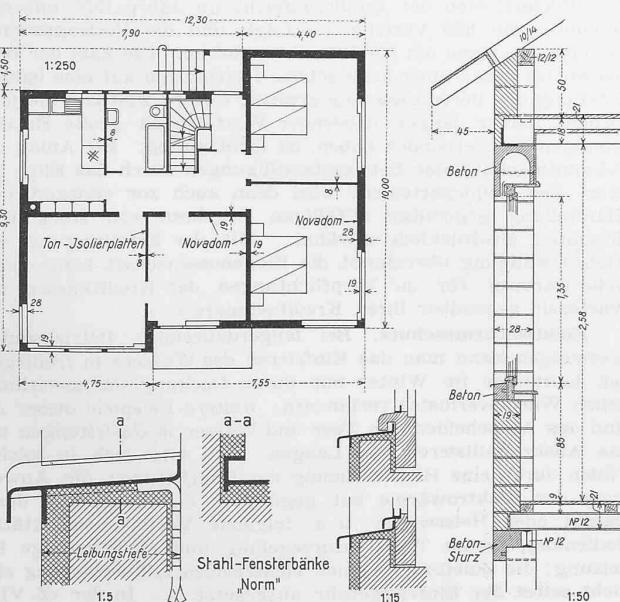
Wohnhaus Dr. Hautle, Kloten. Grundriss 1:250. Schnitt der Aussenwand und Einzelheiten der Fensterbank «Norm».
